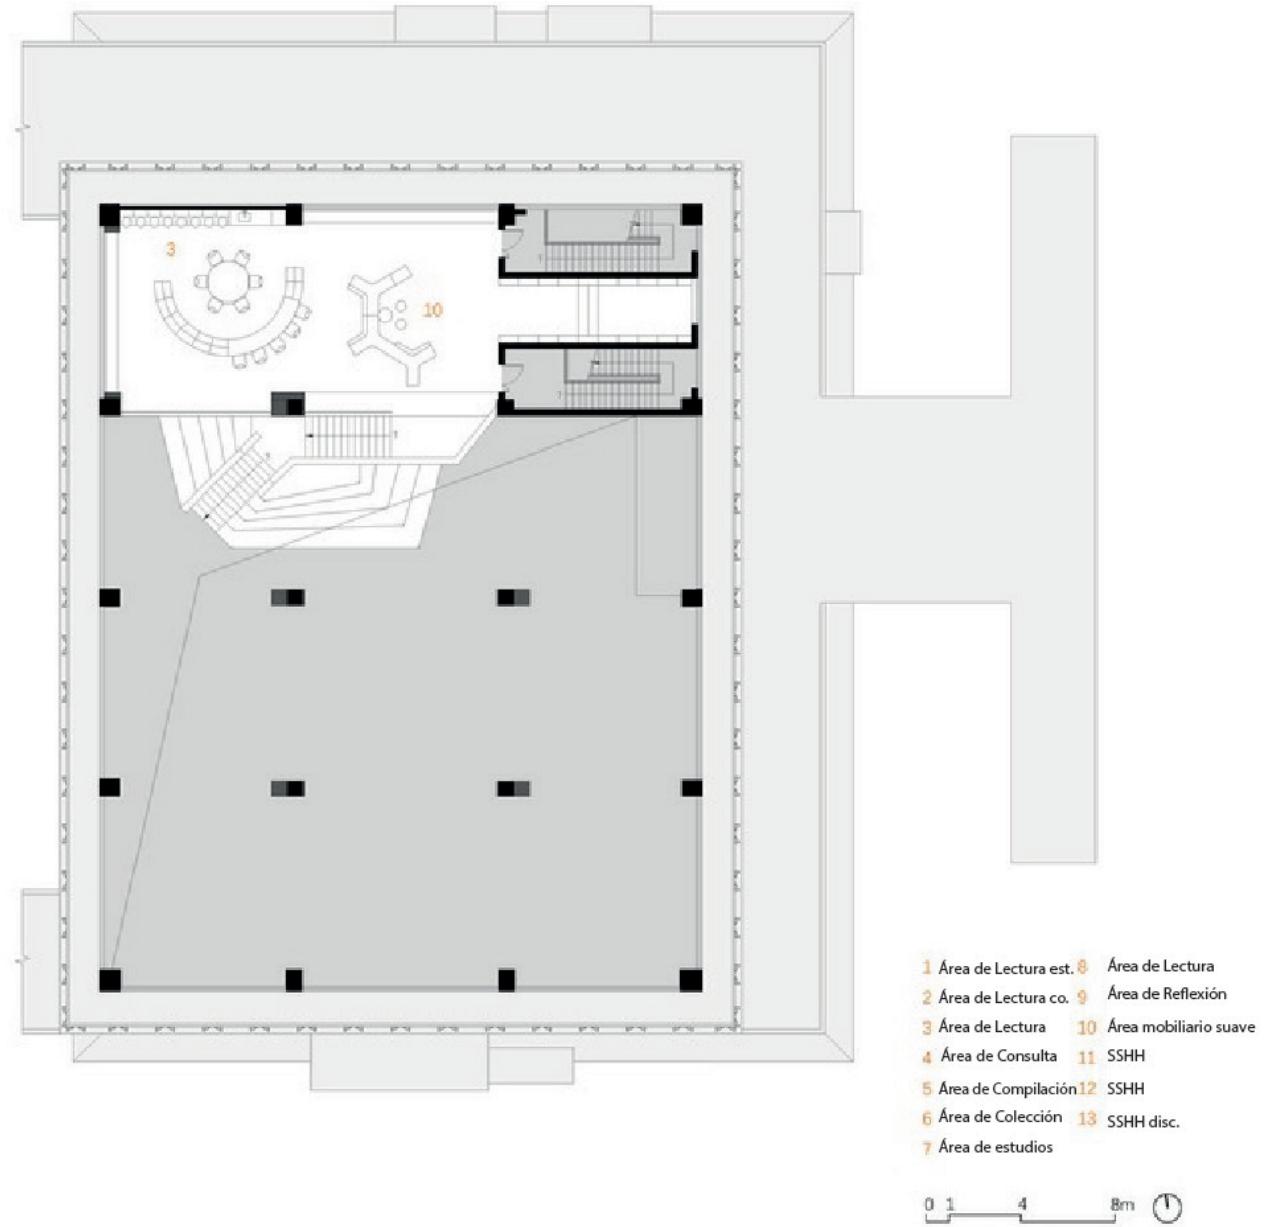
Segunda Planta Alta, Biblioteca Escuela Hebi. Fuente: ArchDaily (2023)
